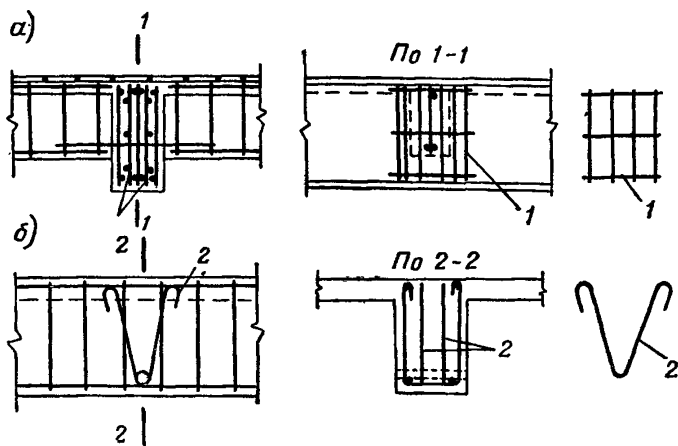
Дополнительное армирование балок в местах действия сосредоточенных нагрузок
